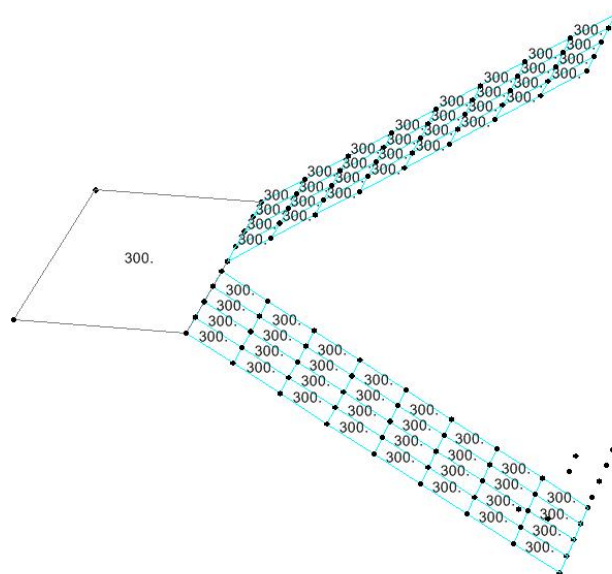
Input Beban Hidup Lantai 1 s/d Lantai 9
